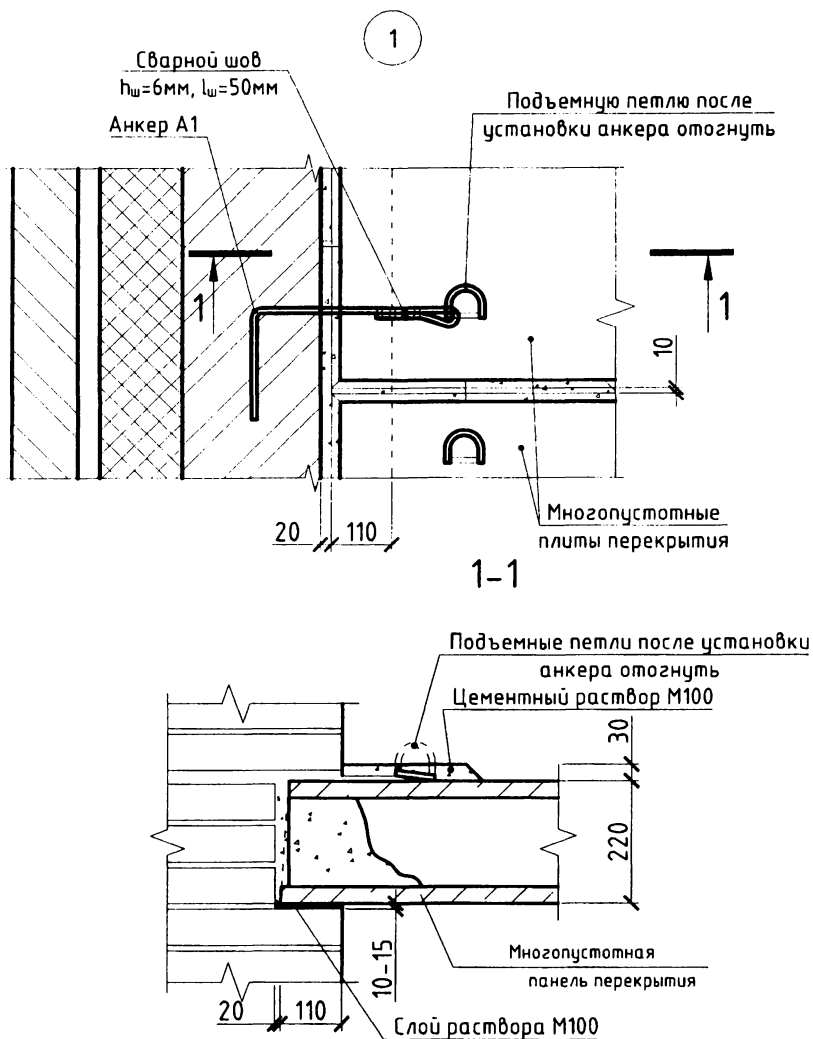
Узел опирания круглопустотной плиты перекрытия на наружную несущую стену из мелкоштучных элементов (смотреть совместно с рисунком 12)
